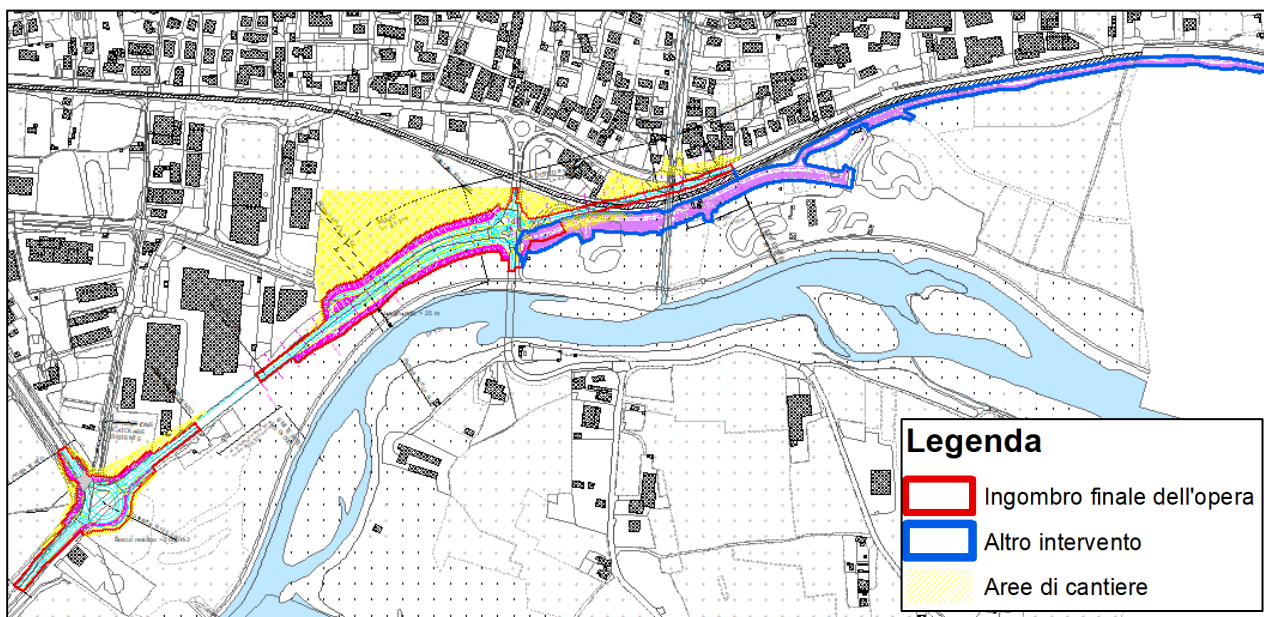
Estratto planimetrico dell'ingombro degli interventi previsti ed assetto finale dell'area
